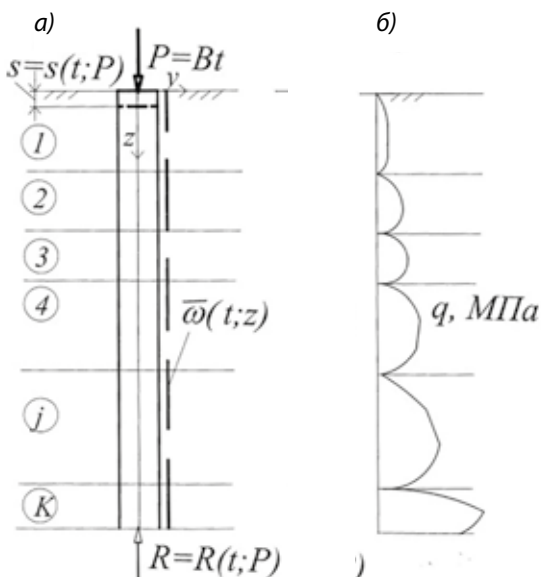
Принципиальная схема испытания грунтов сваей (а). Эпюра лобового сопротивления грунтов зонду (б)
